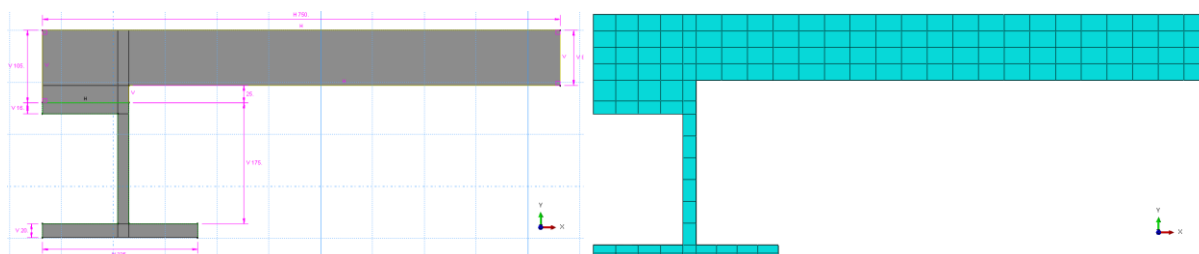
Sketch e malha de elementos finitos de meia secção transversal da viga HB.
